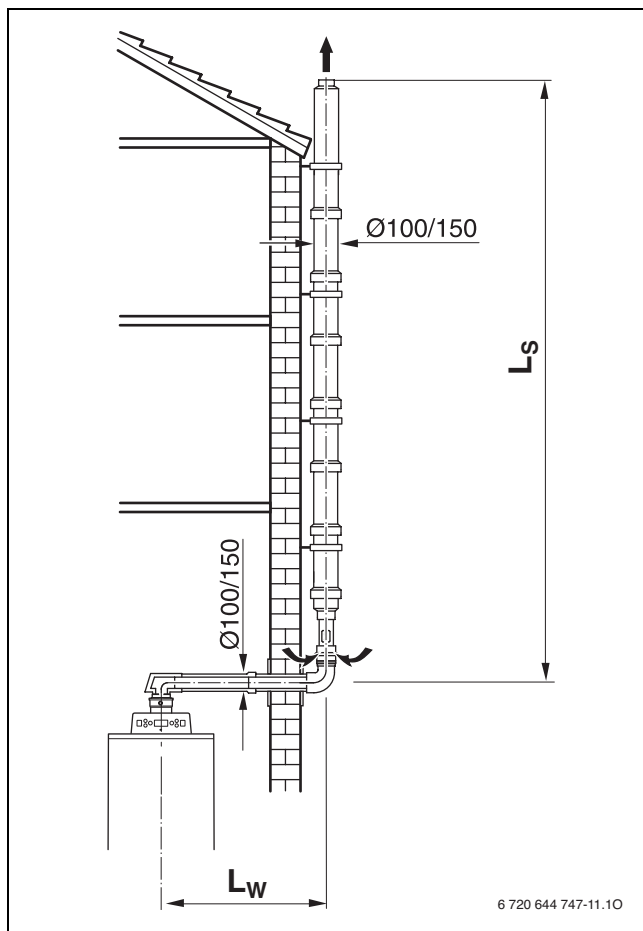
Doppelrohrführung an der Fassade ($C_{53(x)}$)
